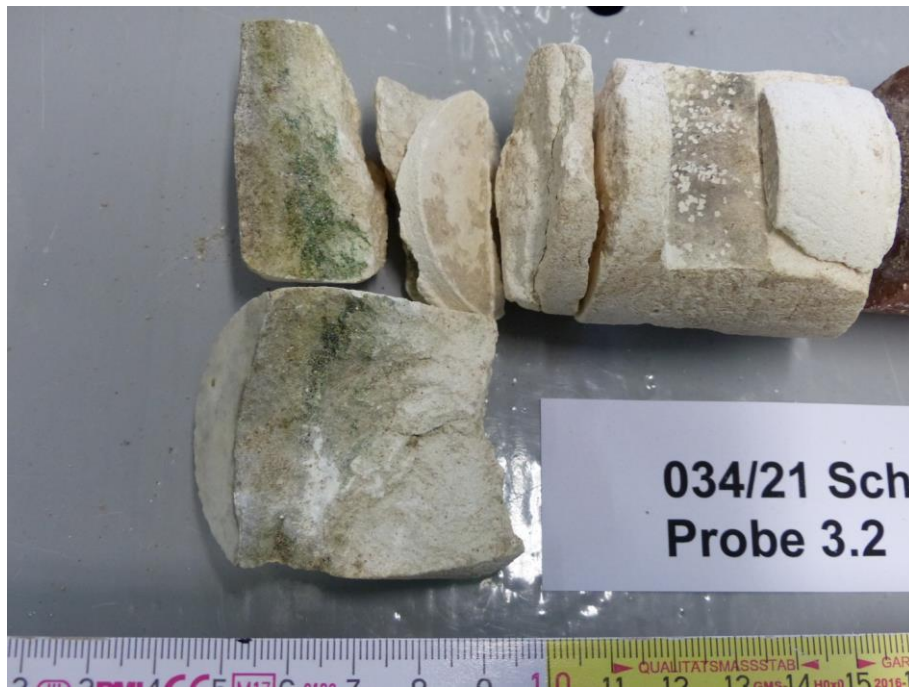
Detail: Bohrung auf Riss – Riss nur in Verblendstein
